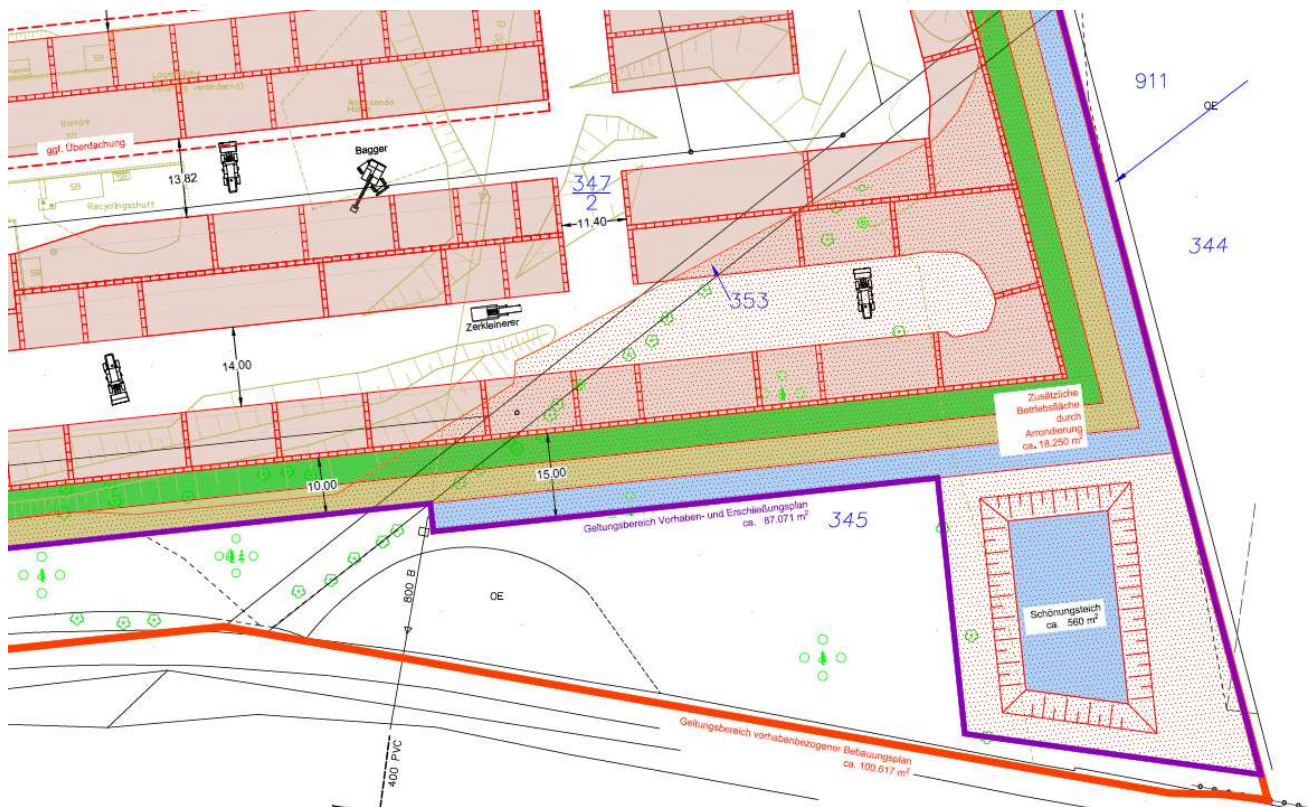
Südöstliche Ecke des Anlagengrundstücks mit Darstellung Arrondierung (gepunktete Fläche), Abriss bestehender Erdwall (grüne Striche), neuer Schönungsteich (blau), Neubau Entwässerungsgraben (blau), Neubau Pflegeweg (ocker) und Neubau Erdwall/Böschung (grün)
